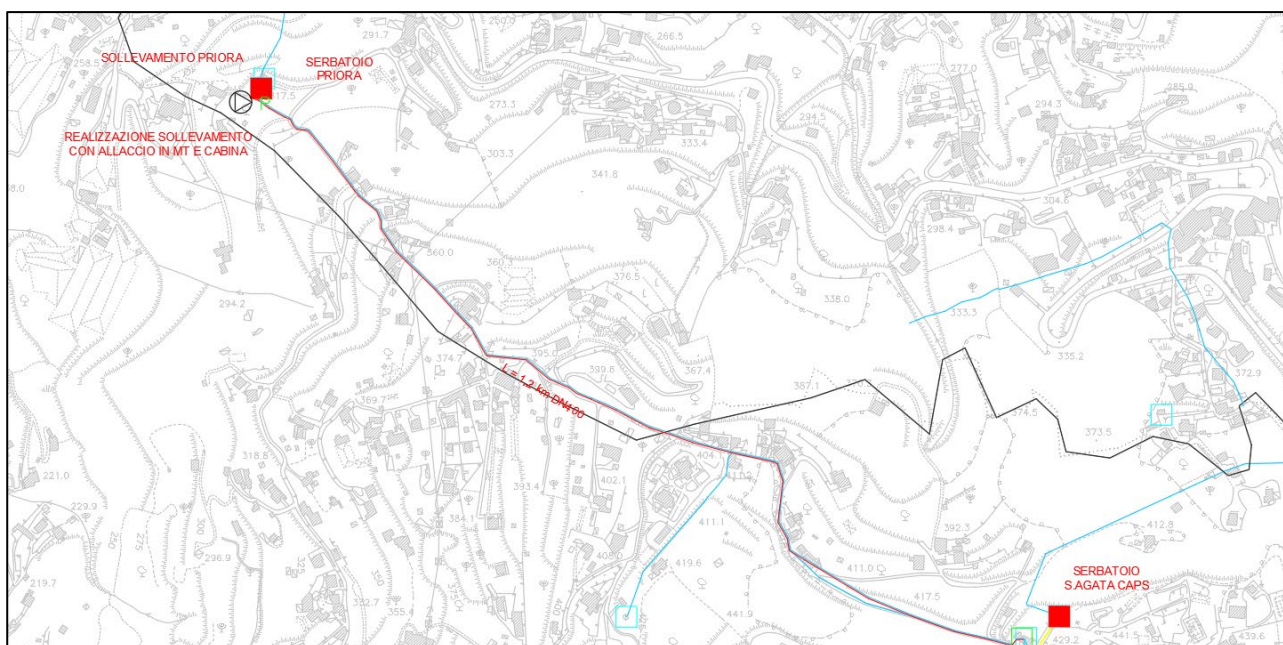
Planimetria Intervento Piora – Sant'Agata Caps
